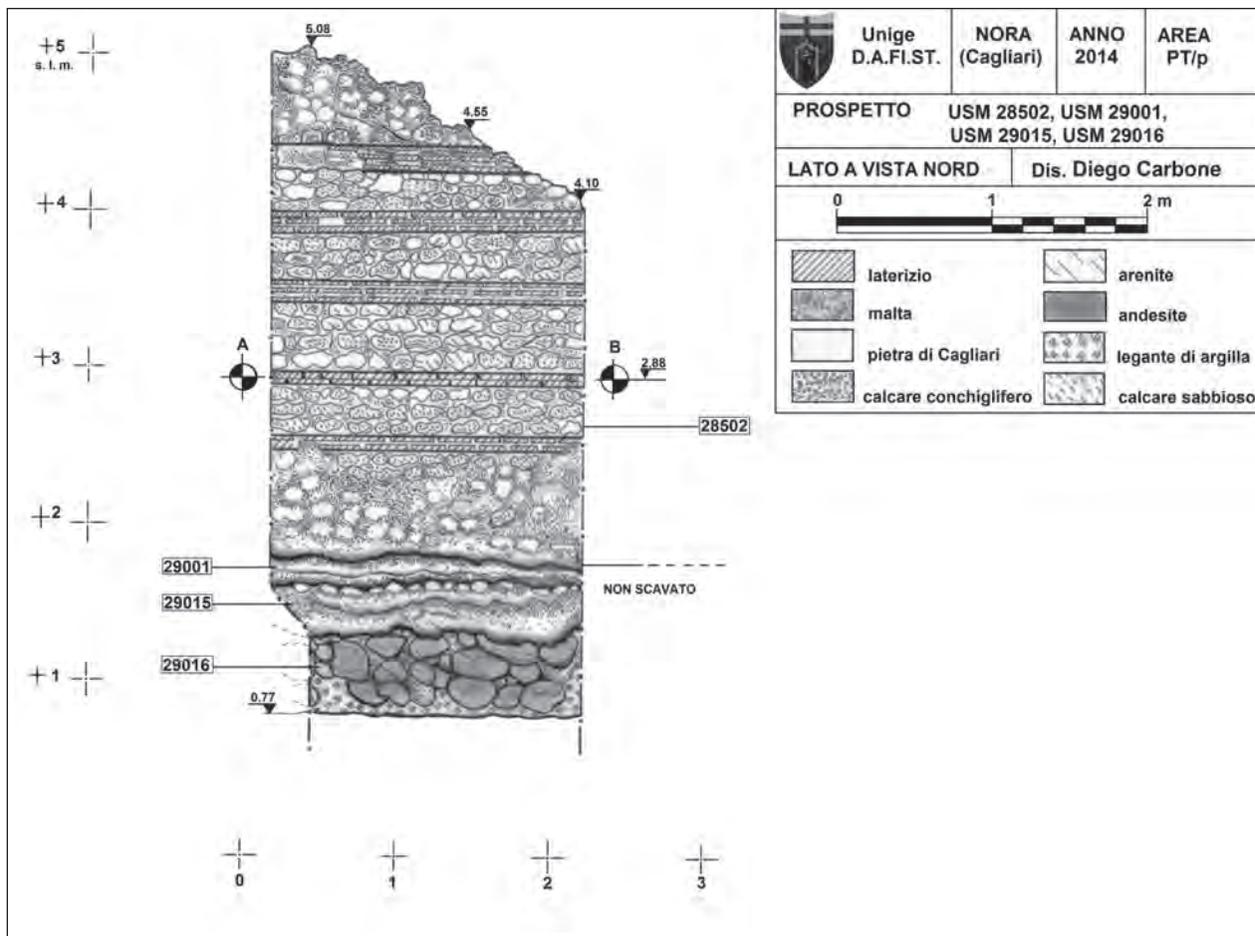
Nora, Area PT/p. Prospetto del muro S del *praefurnium*.
